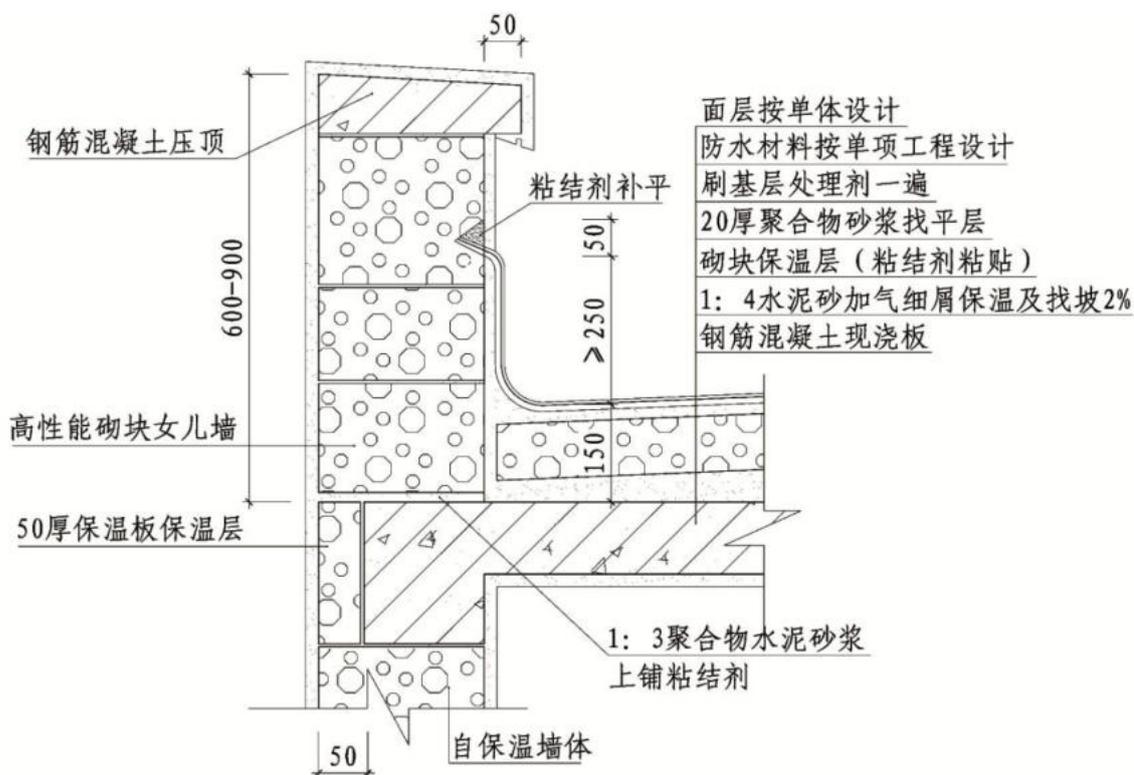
屋面保温防水构造（不上人屋面）
